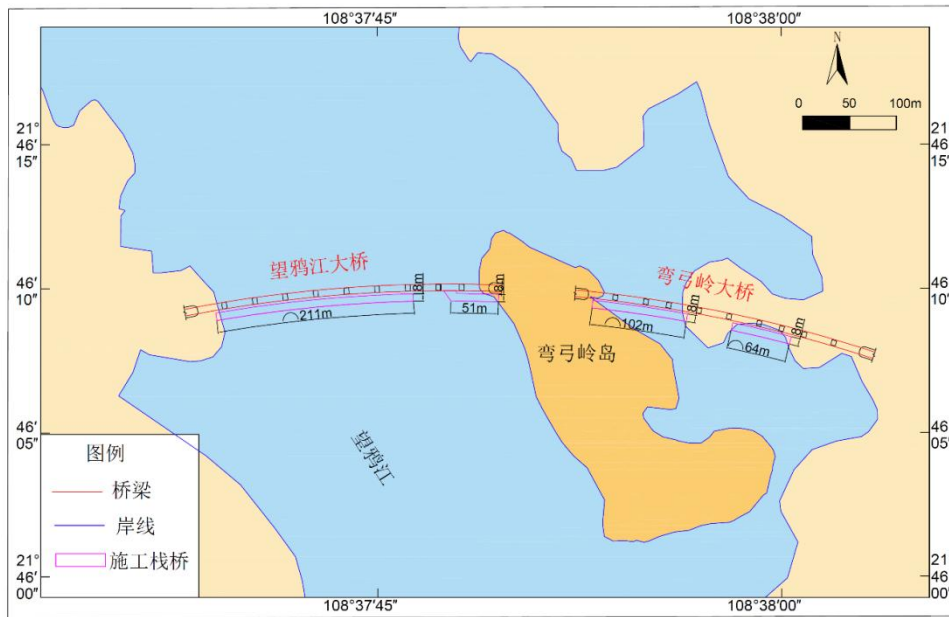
望鹤江大桥、弯弓岭大桥施工栈桥平面布置图
